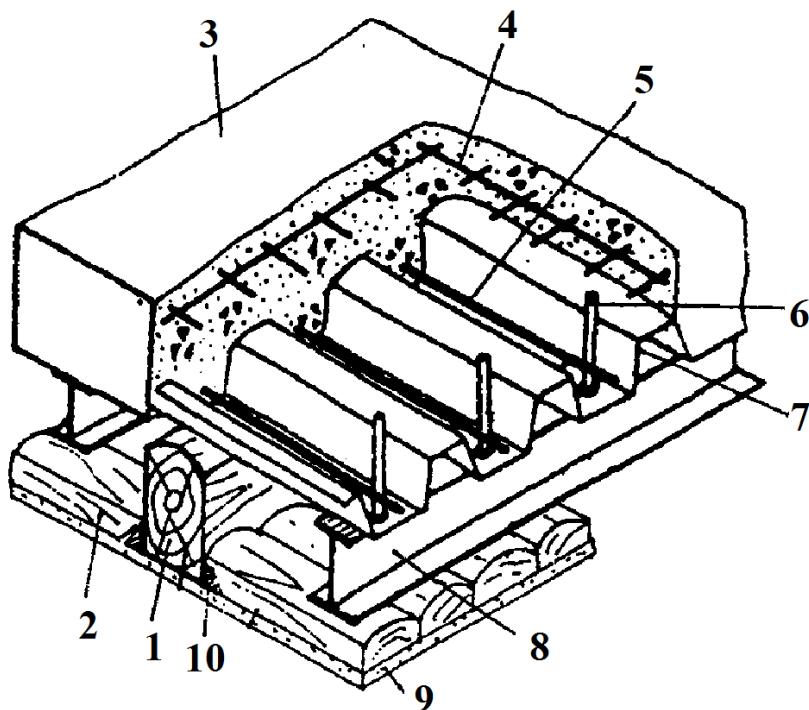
Конструктивна схема посилення дерев'яного перекриття шляхом влаштування монолітної залізобетонної плити по металевих балках: 1 – існуюча дерев'яна балка; 2 – накат з пластин; 3 – монолітний бетон; 4 – арматурна сітка; 5 – робоча арматура; 6 – вертикальний анкер; 7 – сталевий профільований настил (незнімна опалубка); 8 – металева балка; 9 – штукатурка по дранці; 10 – черепної бруса
